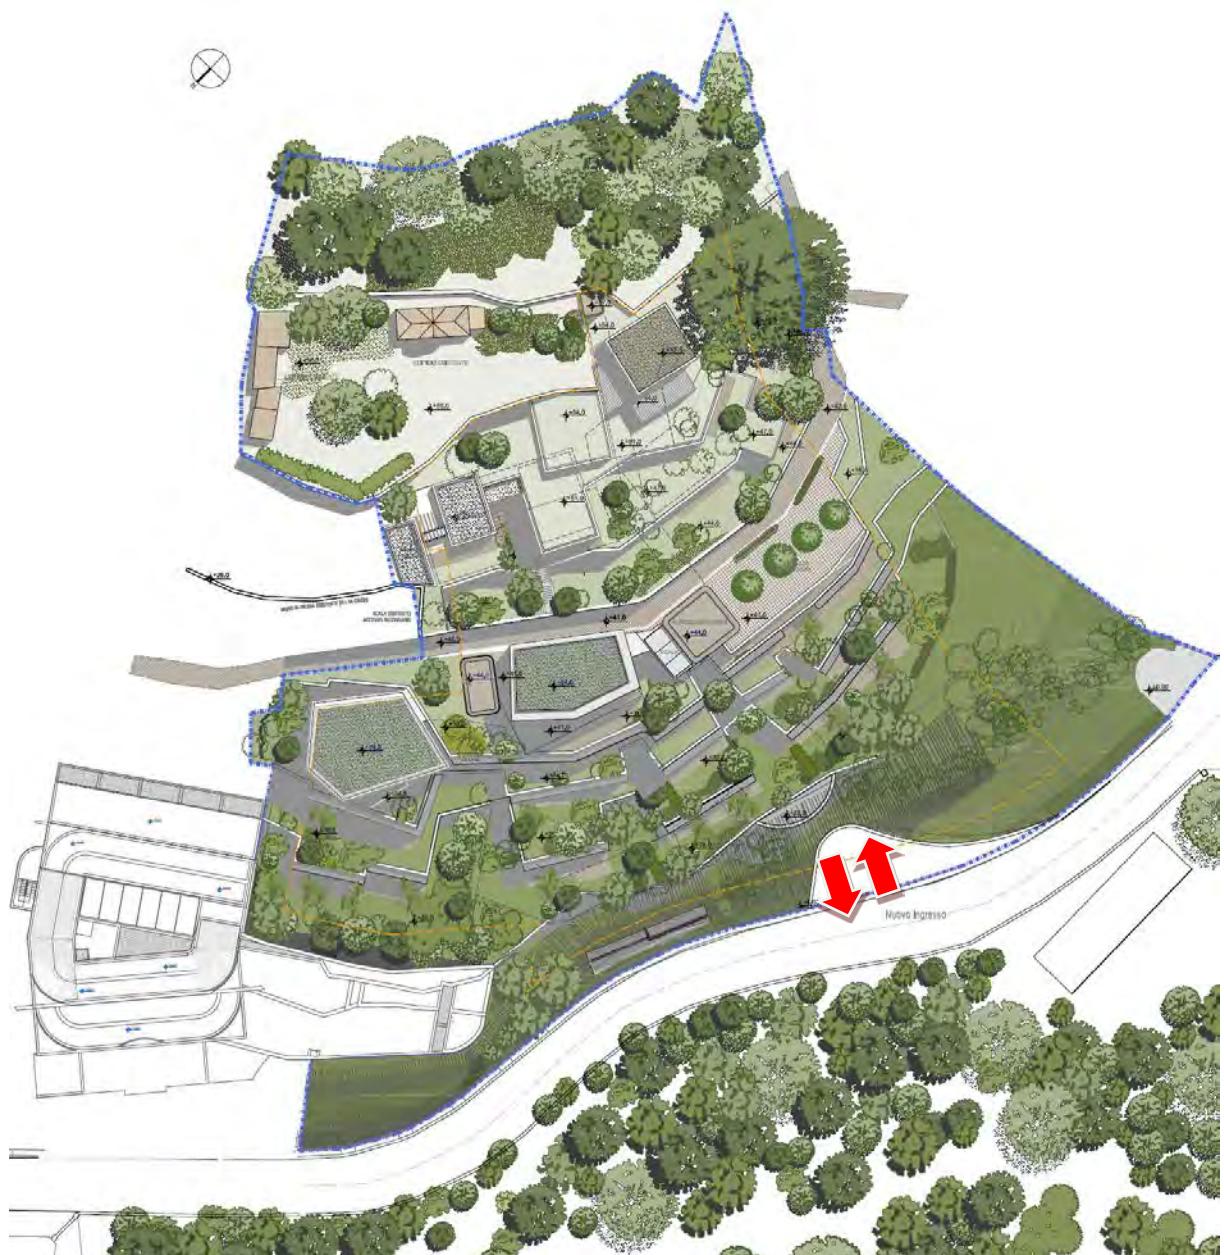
PA Colombaio – Planimetria di progetto e accesso ai parcheggi interrati
